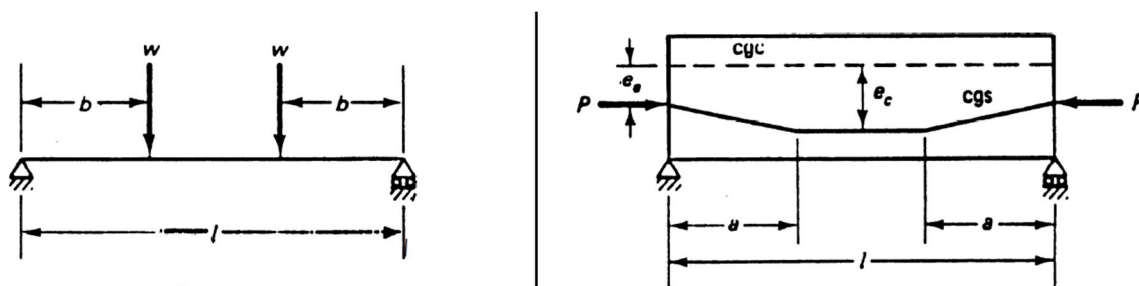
Deformação imediata para vigas pré-esforçadas em fase não fissurada.
